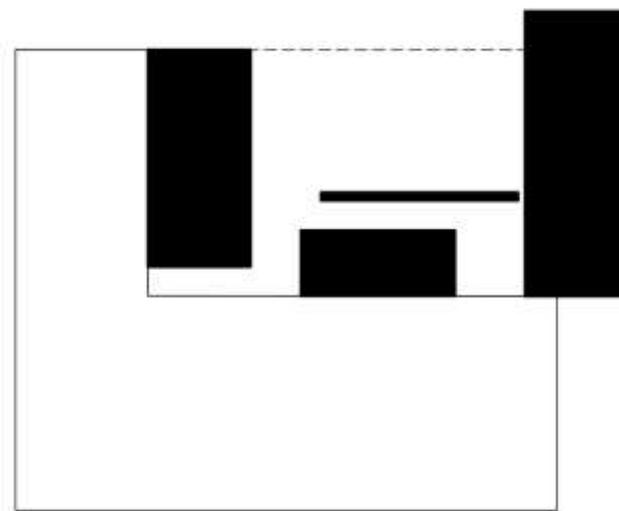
Diagramme de l'auteur plan de rez-de-chaussée
